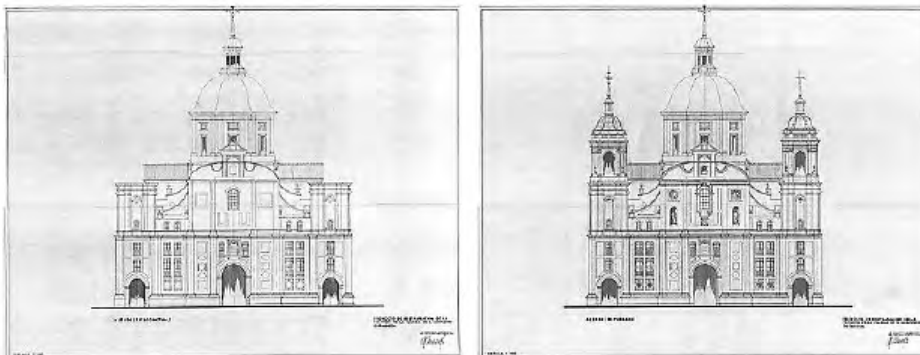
Proyecto de restauración de la fachada de la Iglesia de San Ildefonso de Zaragoza. Izq.: Estado original. Dcha.: Alzado (Reformado).
